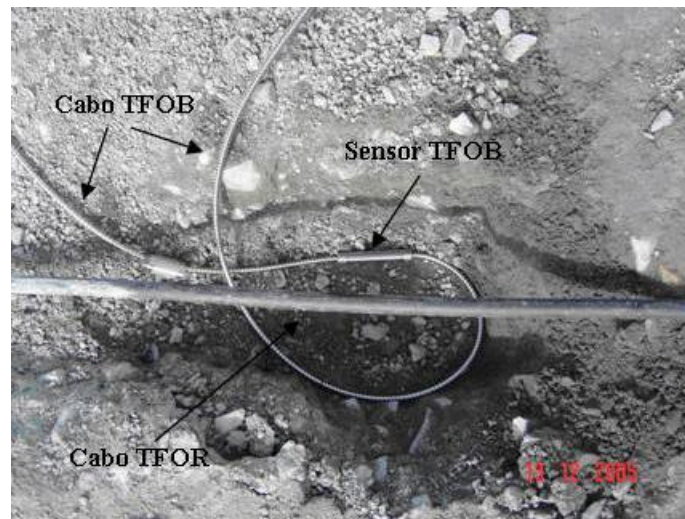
TERMÔMETRO DE FIBRA ÓTICA UTILIZANDO REDES DE BRAGG-TFOB, APLICADO AO LADO DO CABO TFOR
